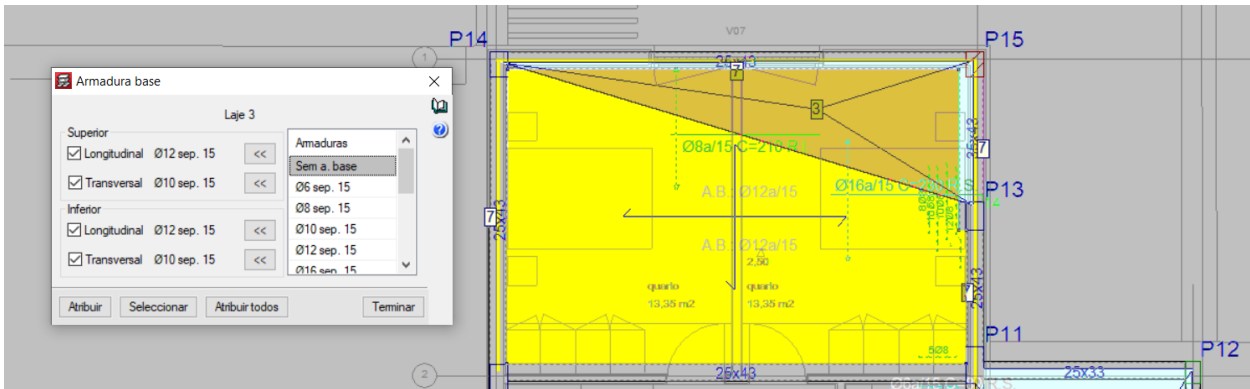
Armadura Base na Laje 3 (Fonte: CYPE)
